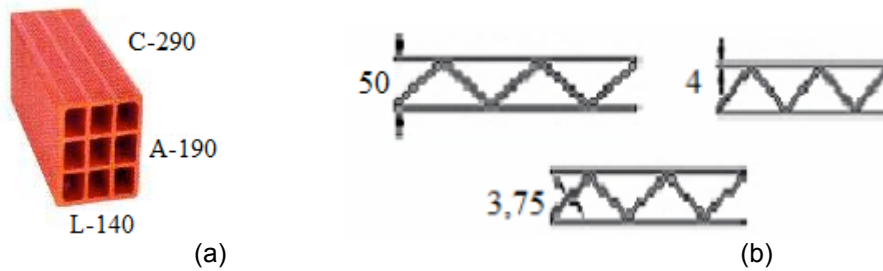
Detalhes do bloco e da armadura utilizados na construção das mini-paredes (dimensões em mm): (a) características geométricas do bloco cerâmico furado de vedação; (b) dimensões da armadura em treliça de aço galvanizado – armadura Murfor (RND-Z. 4/50).
